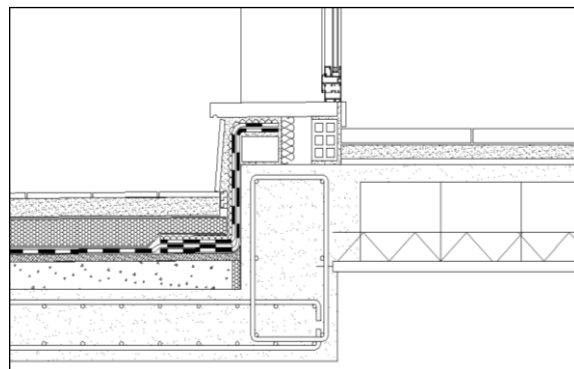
Detalle de una impermeabilización bituminosa en su encuentro con el umbral de la puerta de acceso a una azotea
